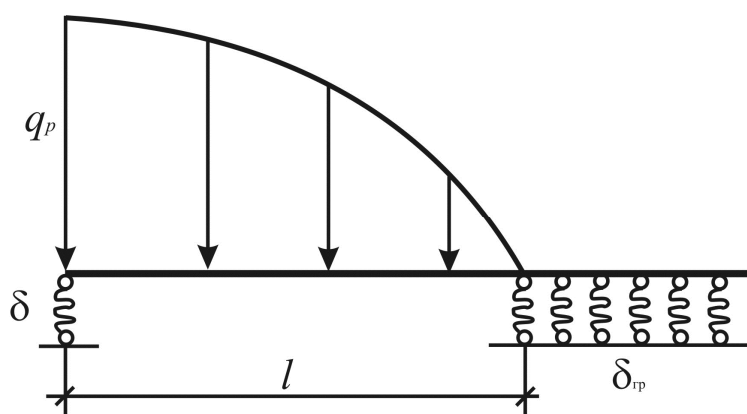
Розрахункова схема випереджаючого екрану з труб
